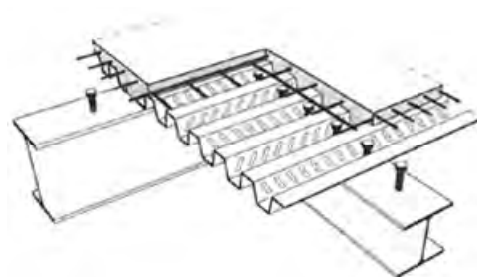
Płyta betonowa ze stalową blachą profilowaną
